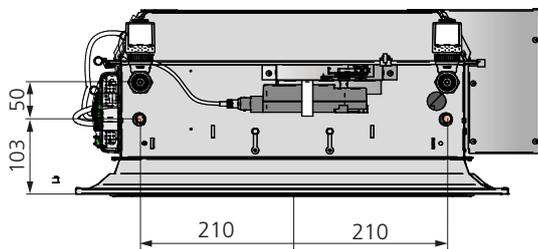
Dimensions, longueur du raccord hydraulique 600, 1200, 1800
